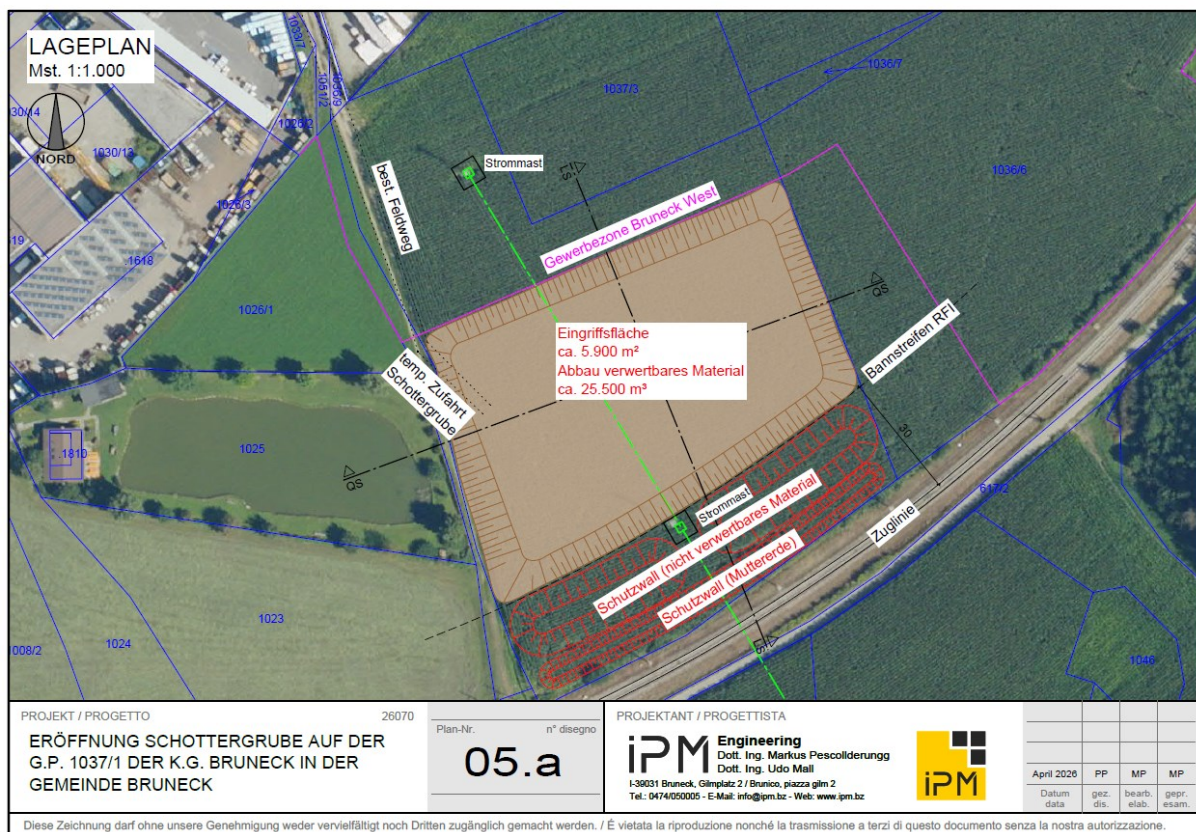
Ausschnitt „Lageplan Projekt“ von Projektunterlagen des Ingenieurbüros IPM
